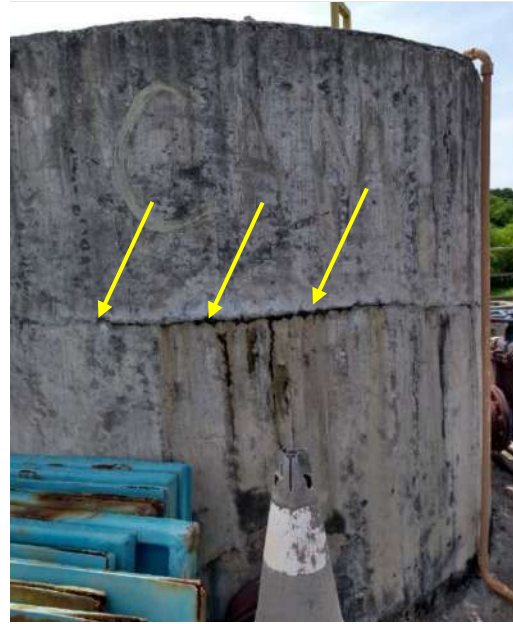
Fissura ao longo do perímetro da CDV1, com pequenos vazamentos ao longo de seu perímetro.
